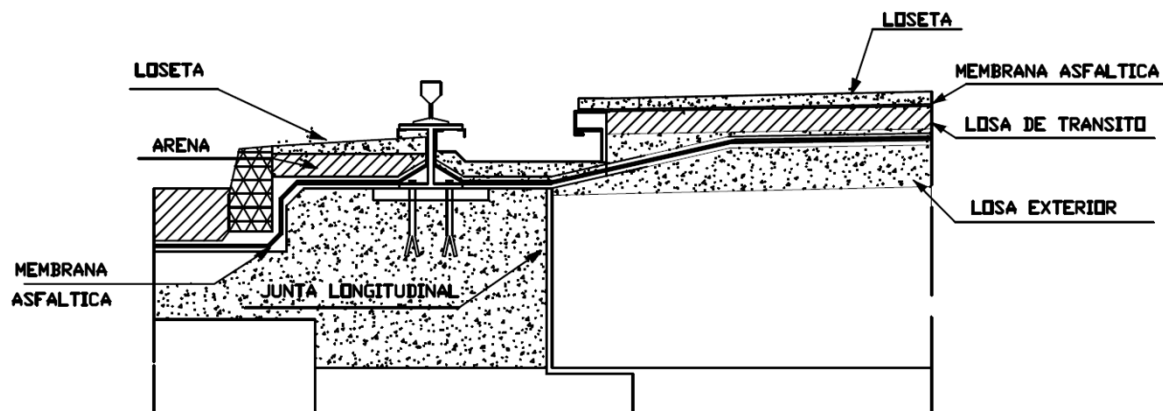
Detalle de tratamiento original de junta longitudinal JL2 (plano ICM-B-III-127c).
